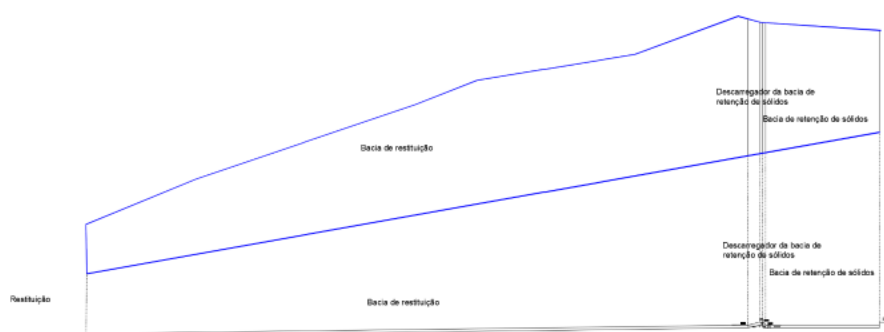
Planta e Perfil da bacia de decantação. (Fonte: RS)
